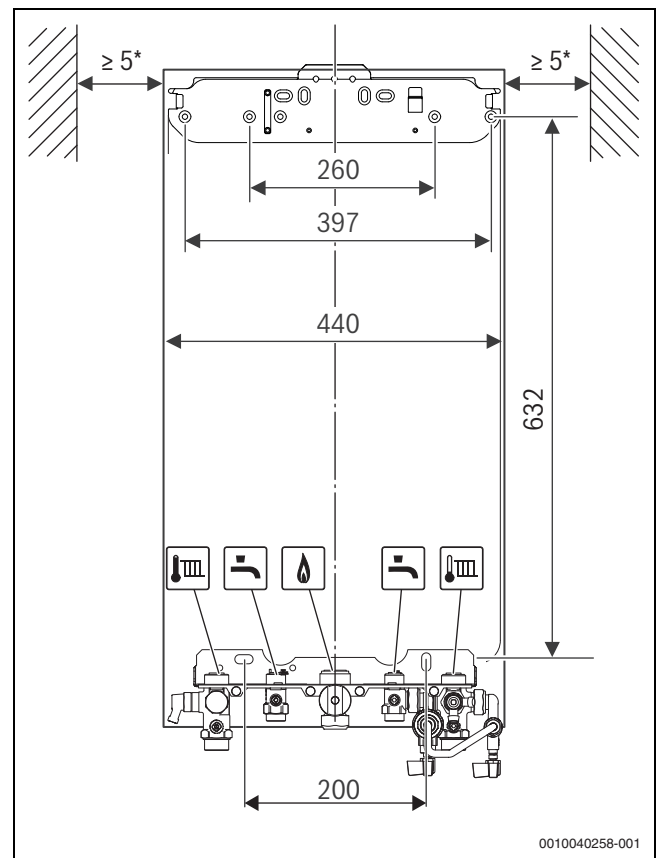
Frontansicht (mm) mit Montageanschlussplatte (Zubehör)
